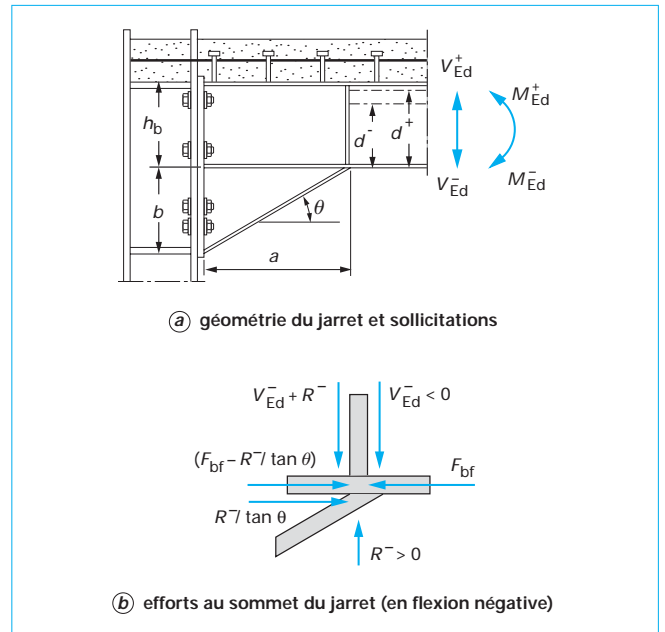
Assemblage mixte avec jarret et modélisation du jarret
